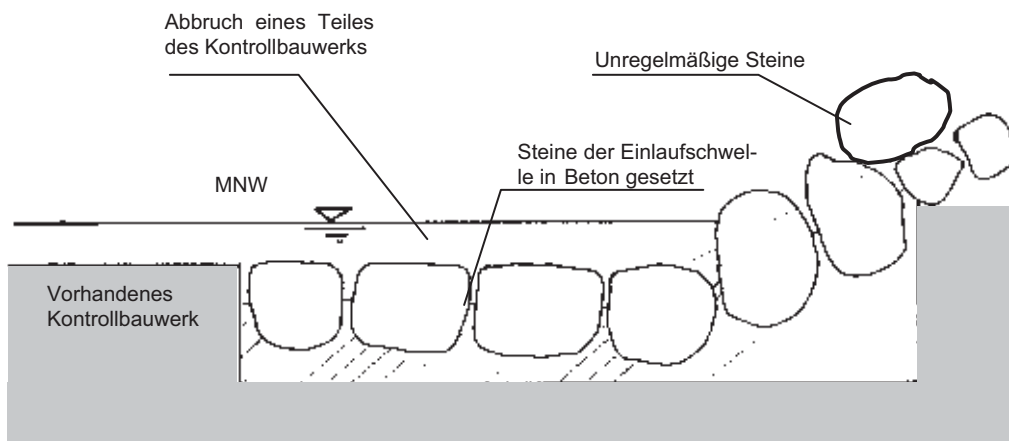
Schnitt A-A, Teilrampe rechts. Pegelschwelle und Rampenkronen auf gleichem Niveau.
